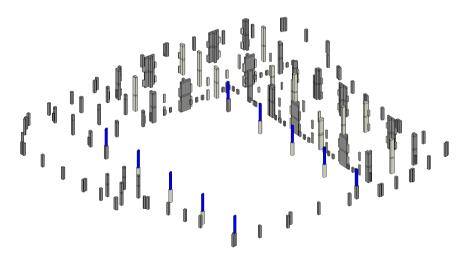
Categoría Pilares Estructurales aislada del modelo federado de Estructuras
